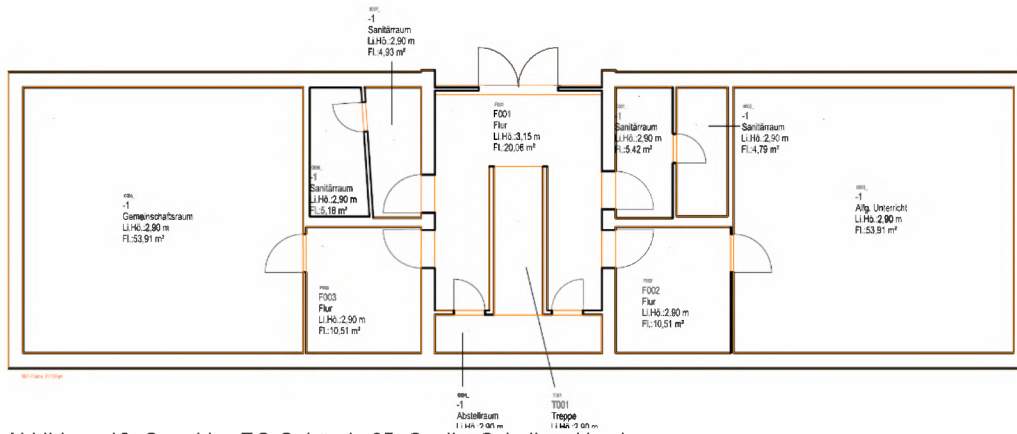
Grundriss EG Gebäude 05, Quelle: Schulbau Hamburg
